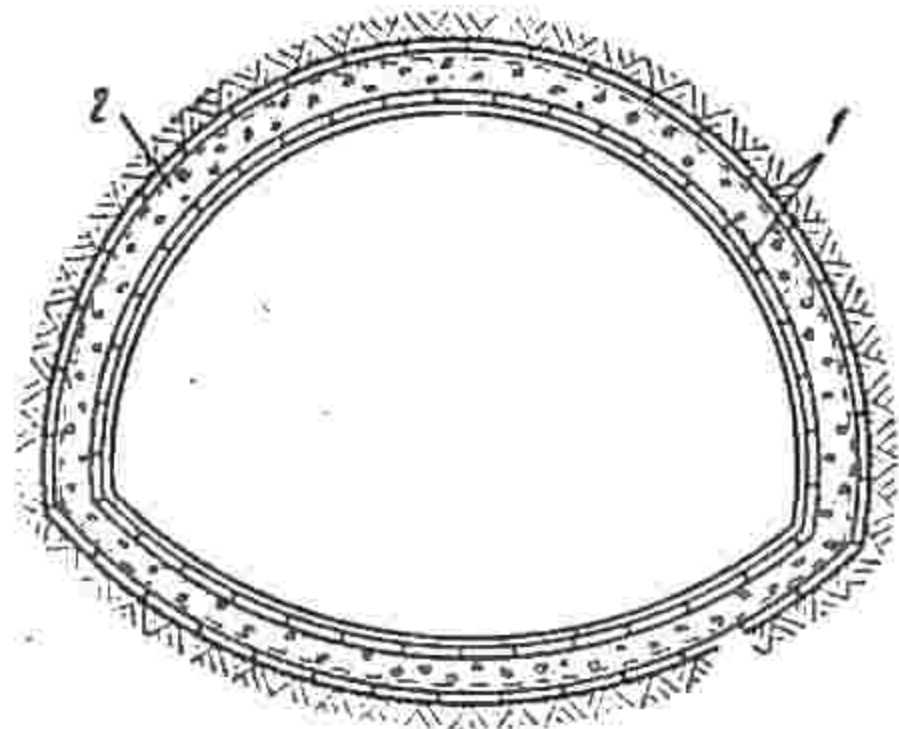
Усиление металлической жесткой крепи замоноличиванием бетоном
